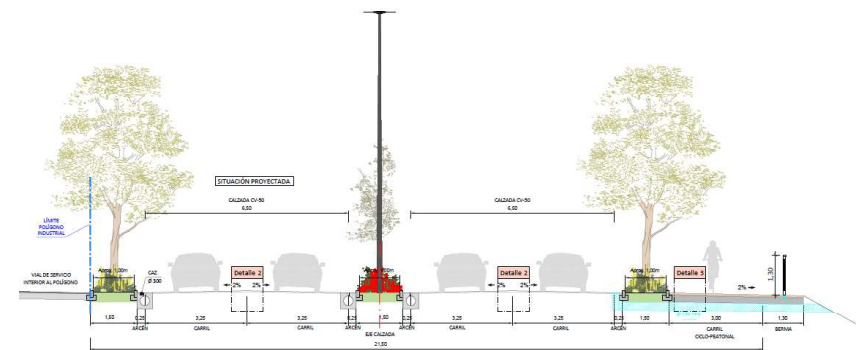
SECCIÓN TIPO DEL TRONCO DE LA VARIANTE DE LA CV-50 (ENTRE G1-G3).
